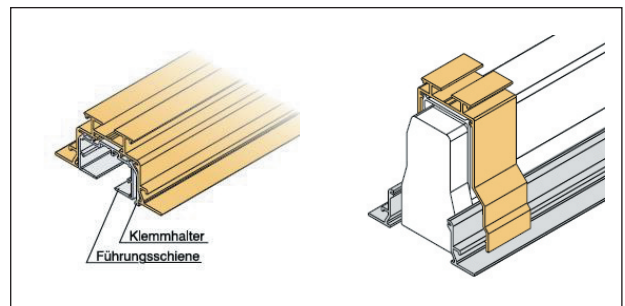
Varianten mit Einbauprofil (Anschauung beispielhaft)
